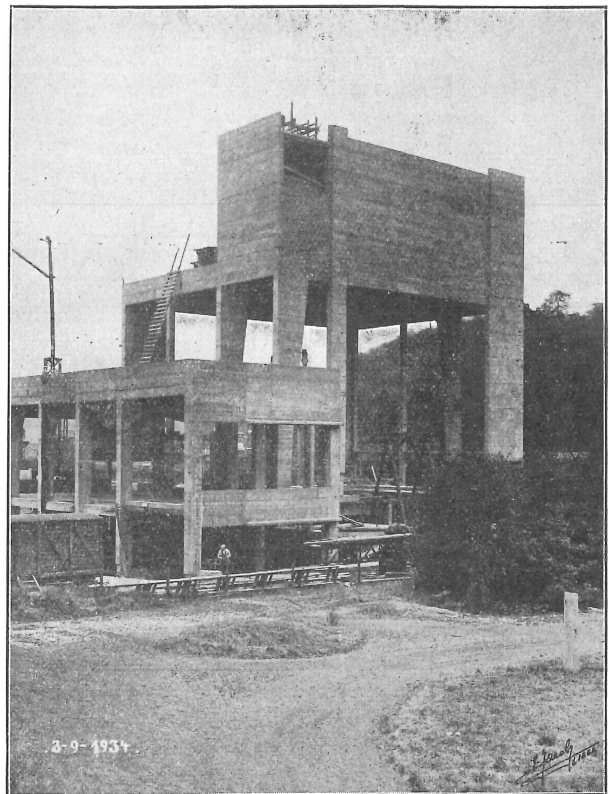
Les portiques en béton armé de la centrale (1934).
